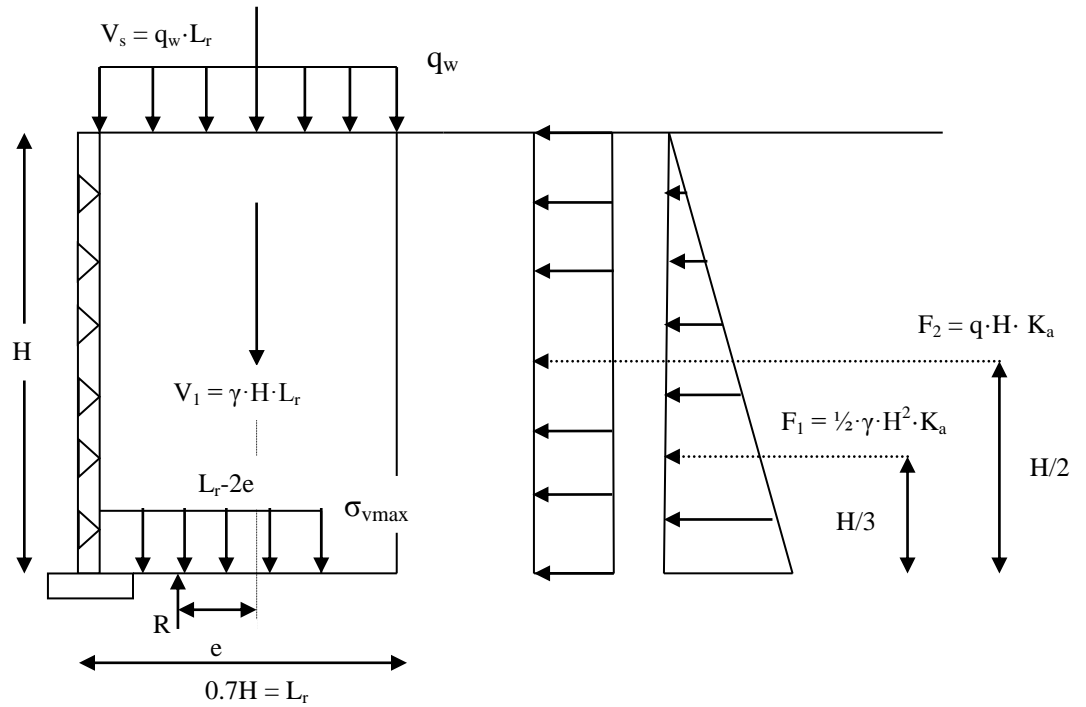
Diagrama de fuerzas que actúan en el muro mecánicamente estabilizado (FHWA, 2009)
